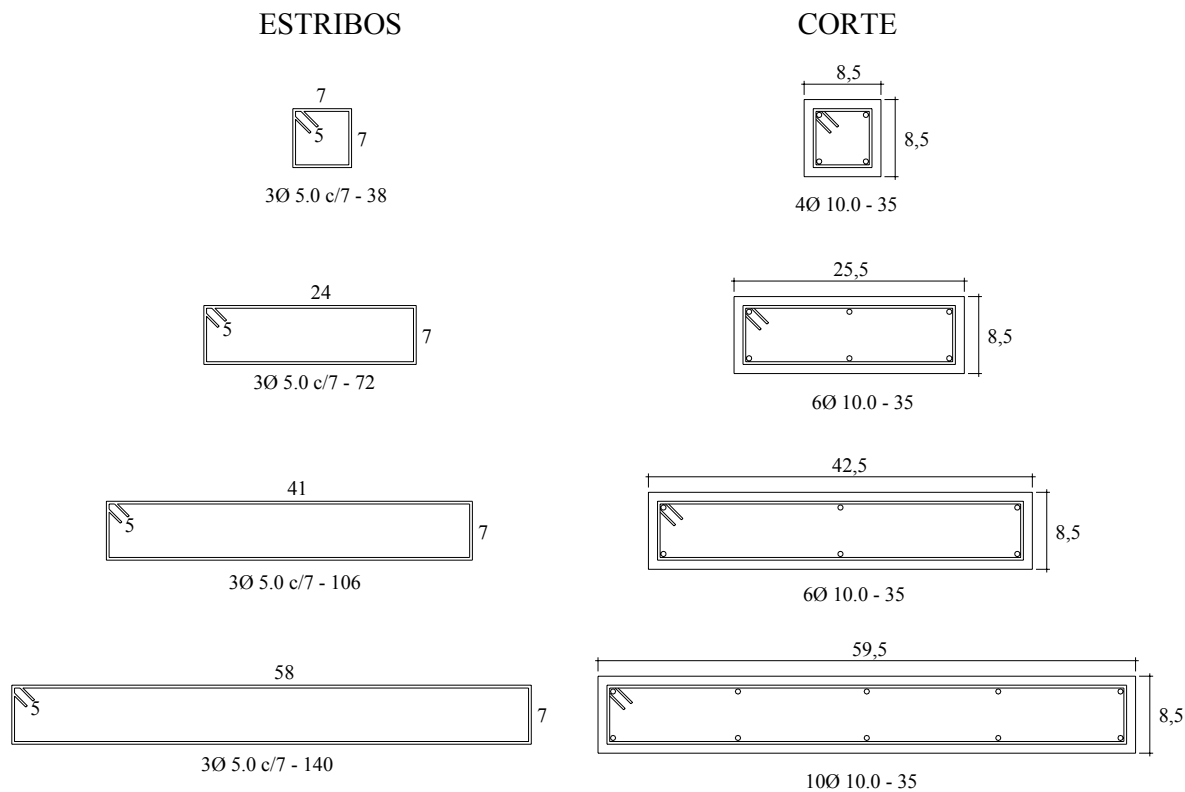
Armadura utilizada nos pilares (dimensões em cm)
